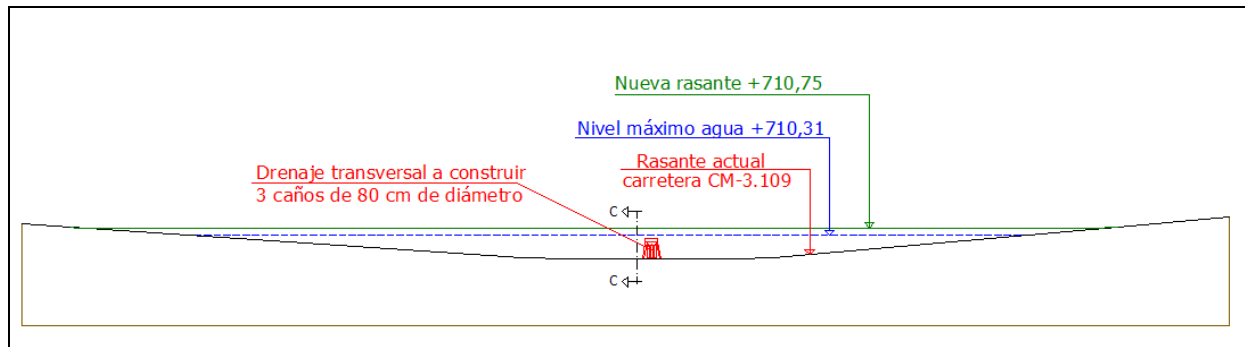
Perfil longitudinal en Represa 4 (Ctra. CM-3.109)
